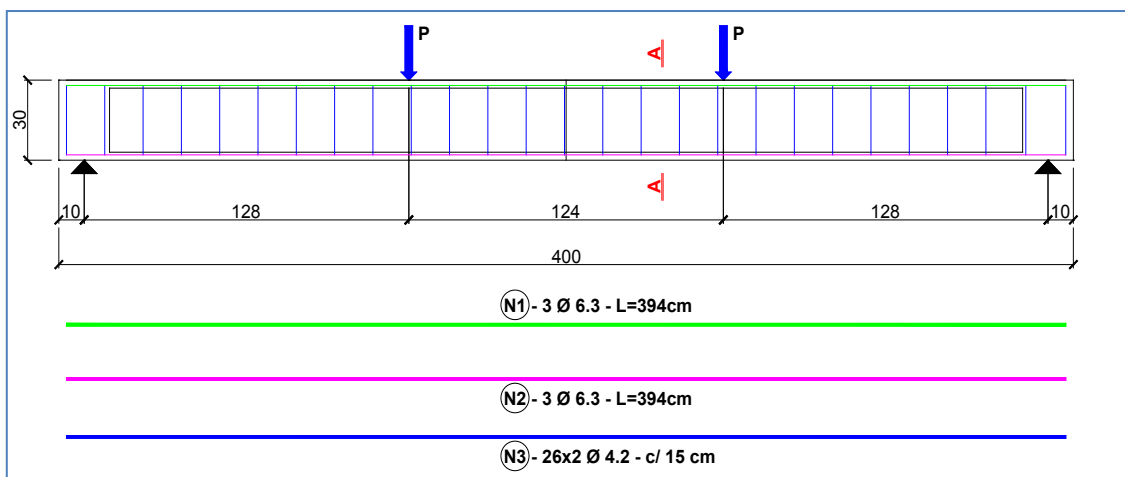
Detalhamento da armadura e pontos de aplicação de forças no ensaio
